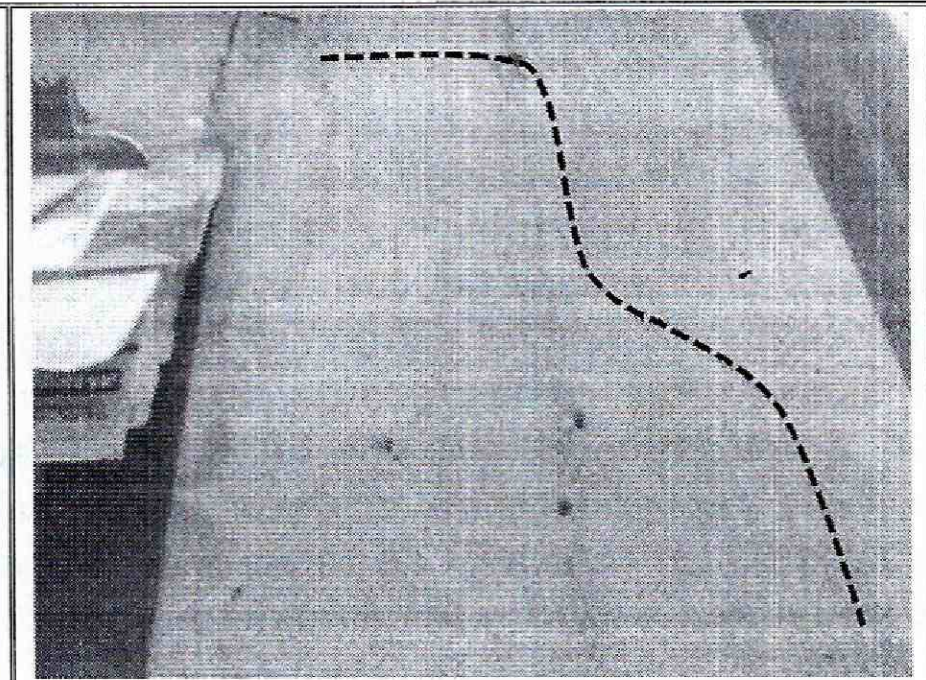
Presencia de fisuras, de tendencia horizontal y vertical, en el costado occidental del muro de cerramiento de la vivienda.
